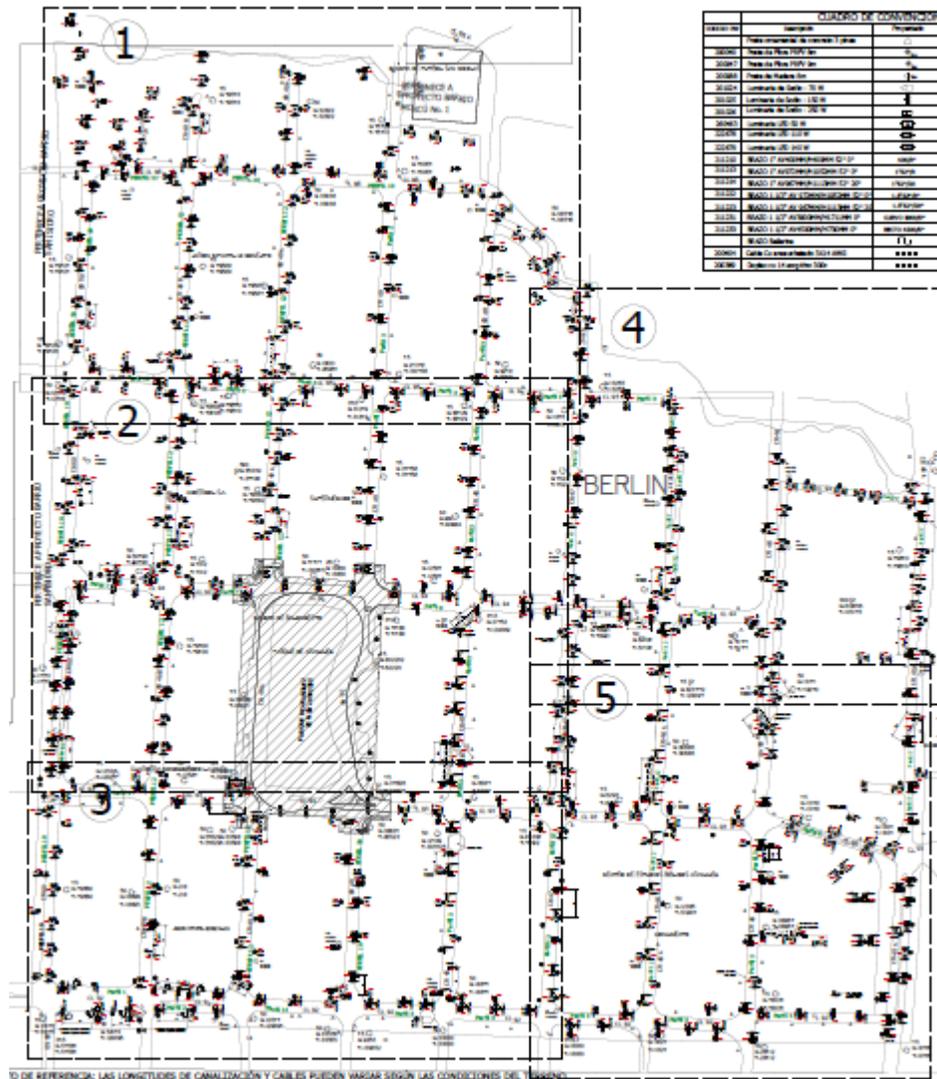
Plano del proyecto SS 175190 Barrio Berlín
